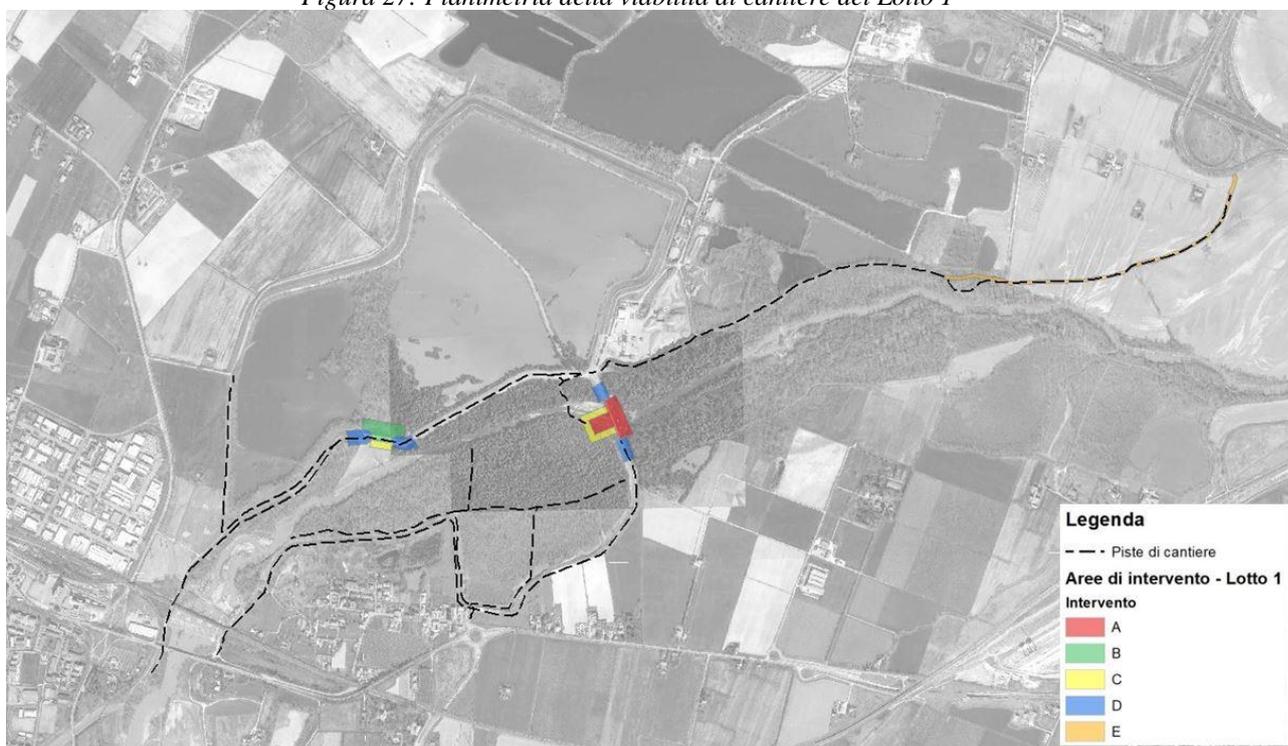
Planimetria della viabilità di cantiere del Lotto 1
